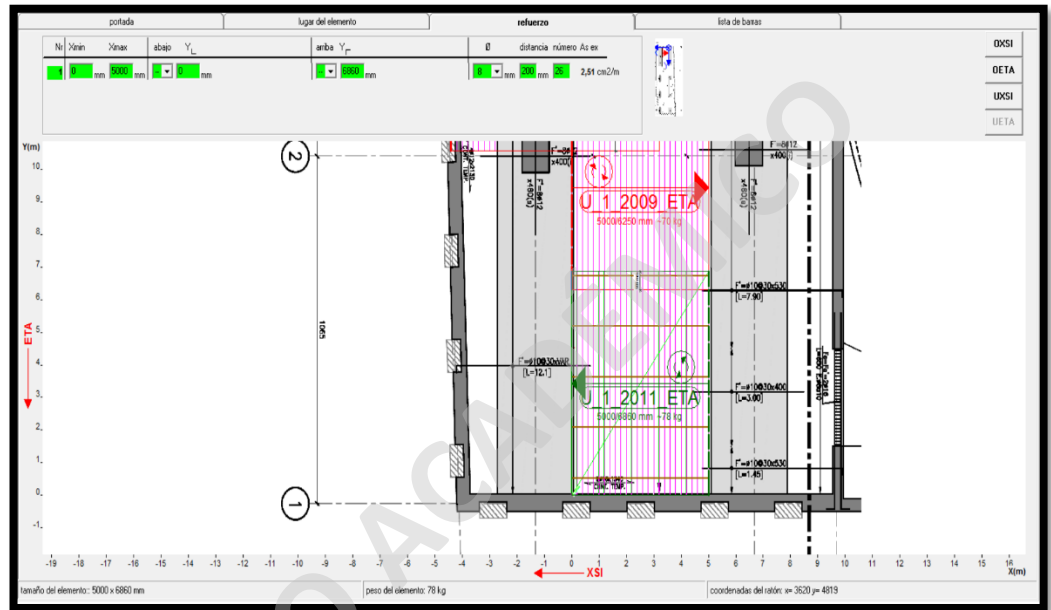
, Plano de elaboración, Fuente: Elaboración propia
